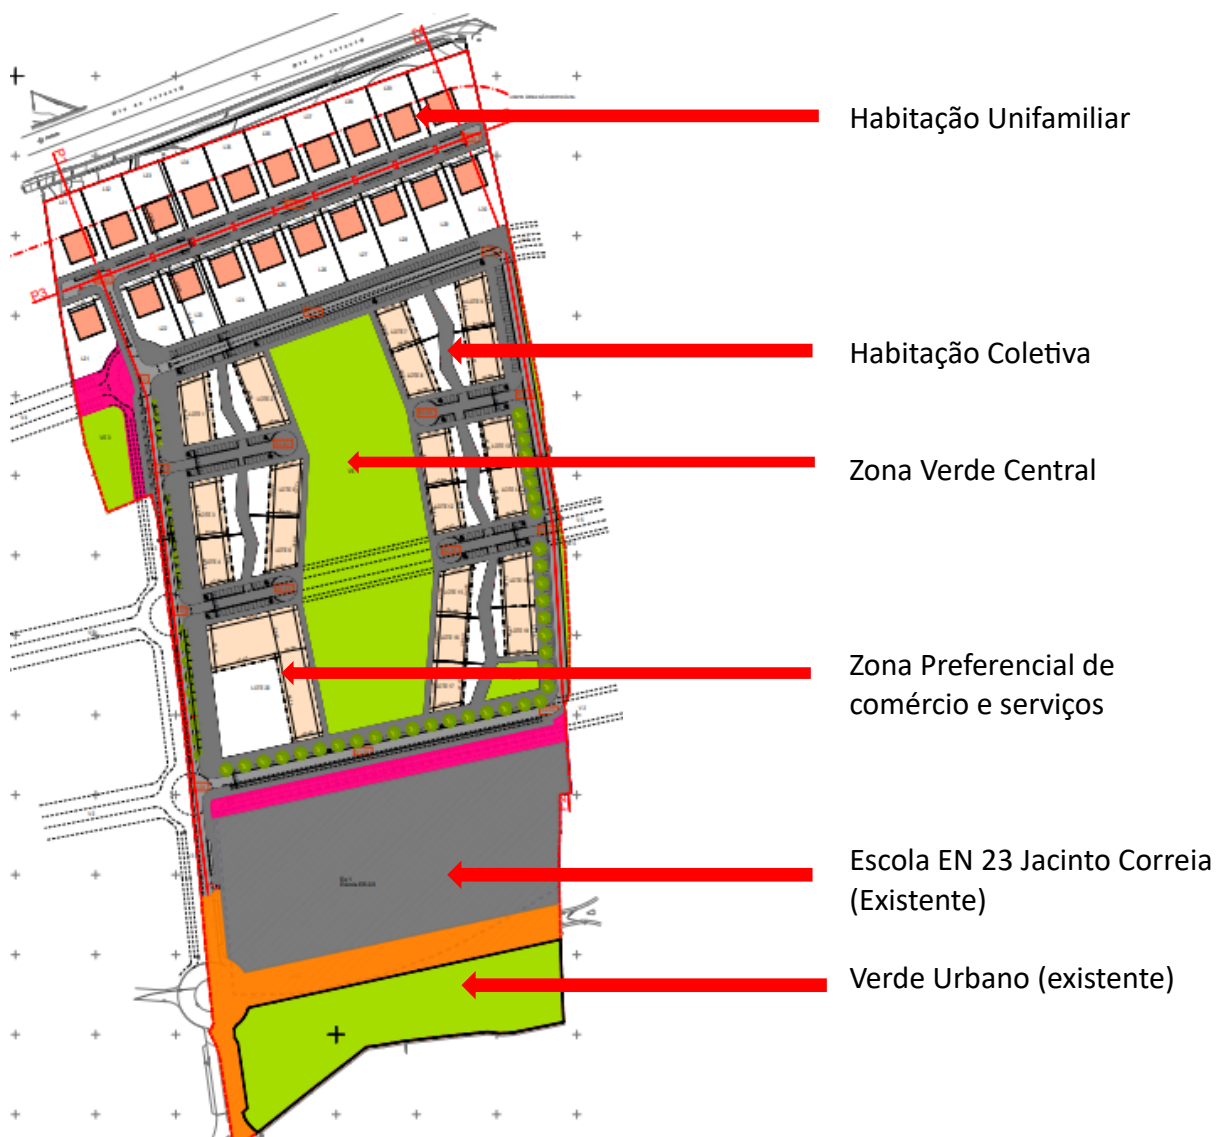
Planta Síntese do Projeto de Loteamento (outubro 2021)
